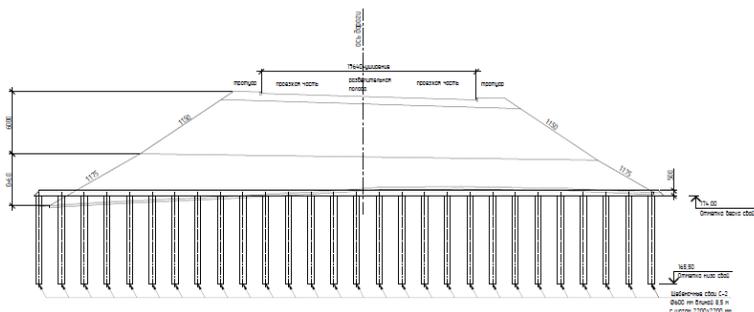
Типовой разрез по дорожной насыпи, усиленного щебеночными армирующими элементами
